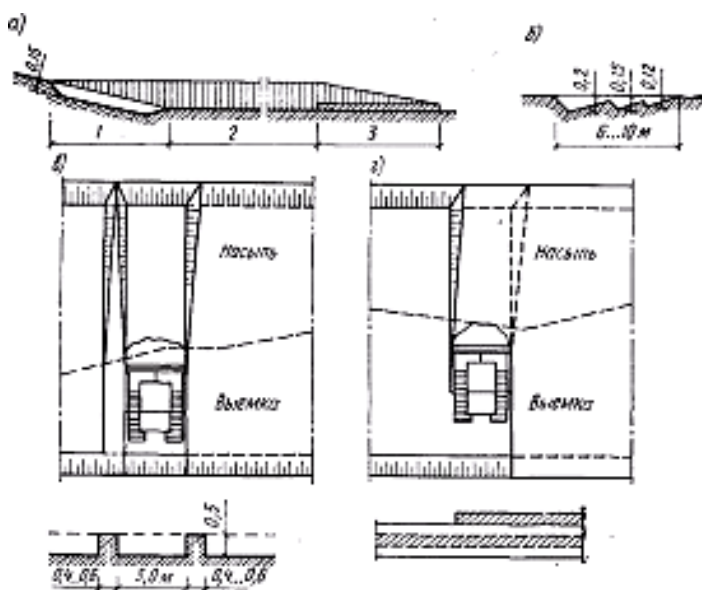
Схемы резания и перемещения грунта бульдозером: а — продольная при резании под уклон; 1 — участок резания при работе под уклон; 2-участок перемещения; 3 — участок разгрузки; б — то же, на горизонтальном участке; в - планировка траншейным способом; г — то же, послойным способом.
